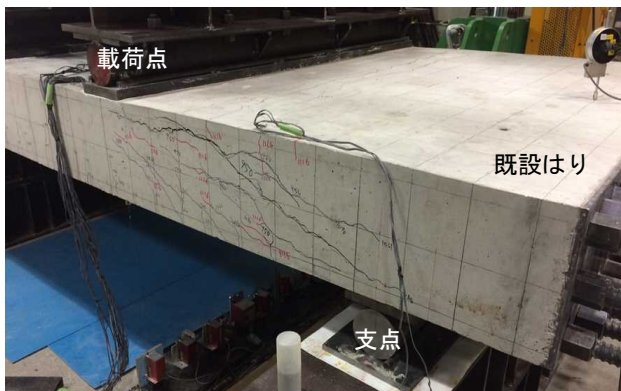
No.1 試験体の最大荷重直後のひび割れ性状
